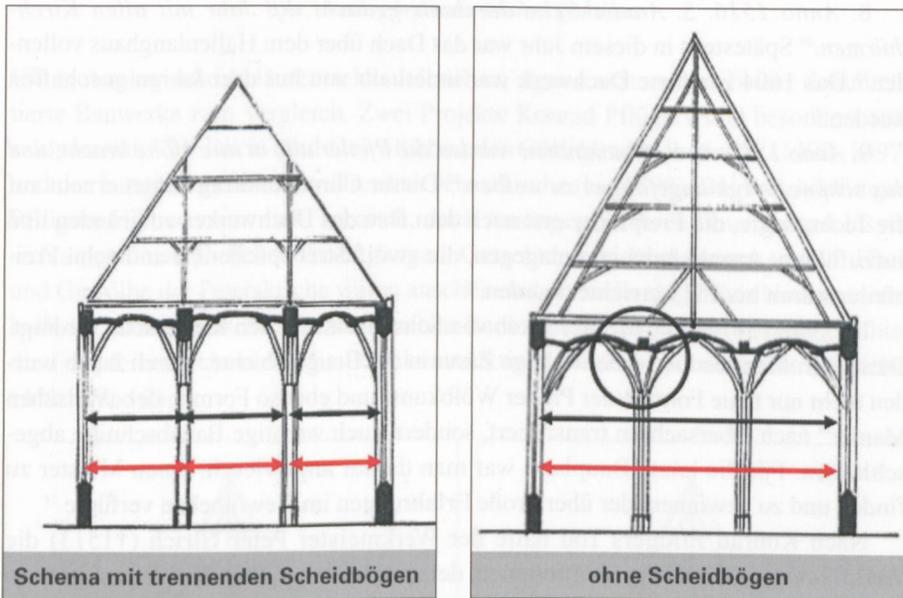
und 5: Schema links: Dach für eine Hallenkirche, bei der die Dachkonstruktion auf den Arkadenbögen aufliegt; rechts: Dach für eine große Hallenkirche, wobei die Konstruktion nicht auf den Arkaden, sondern lediglich auf den Außenmauern lastet [Abb.: Stefan Bürger].
